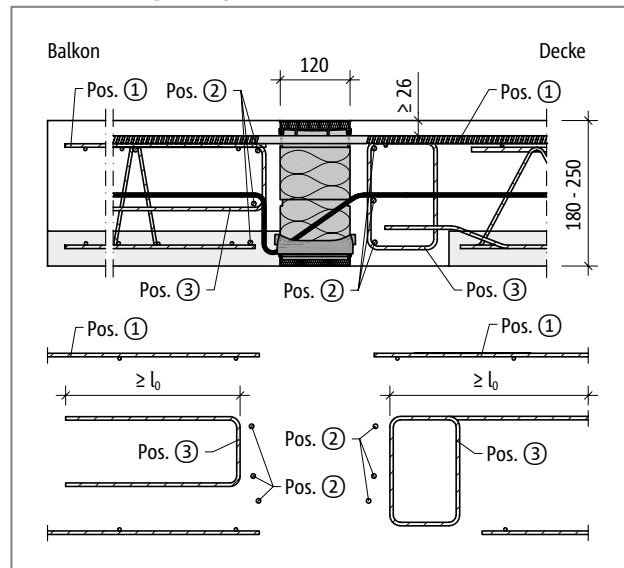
Schöck Isokorb® CXT Typ K-F: Bauseitige Bewehrung bei Balkonplattendicke $h = 180 - 250$ mm
